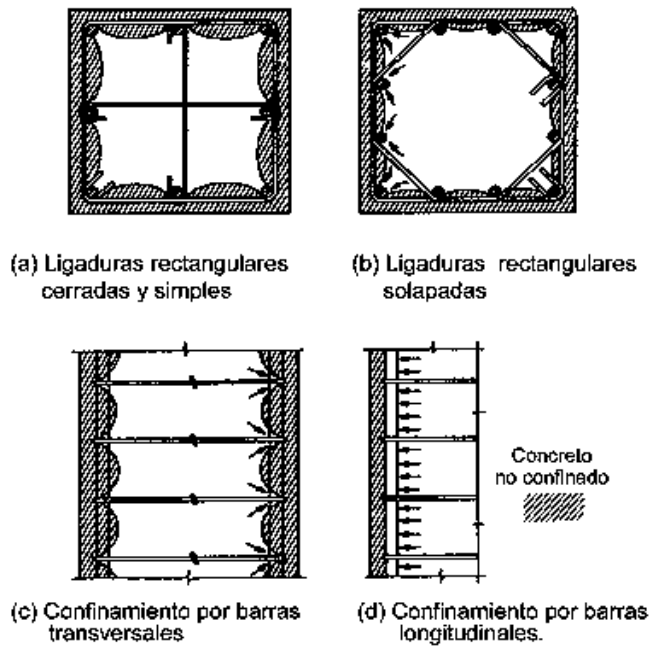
Acero de refuerzo por confinamiento
